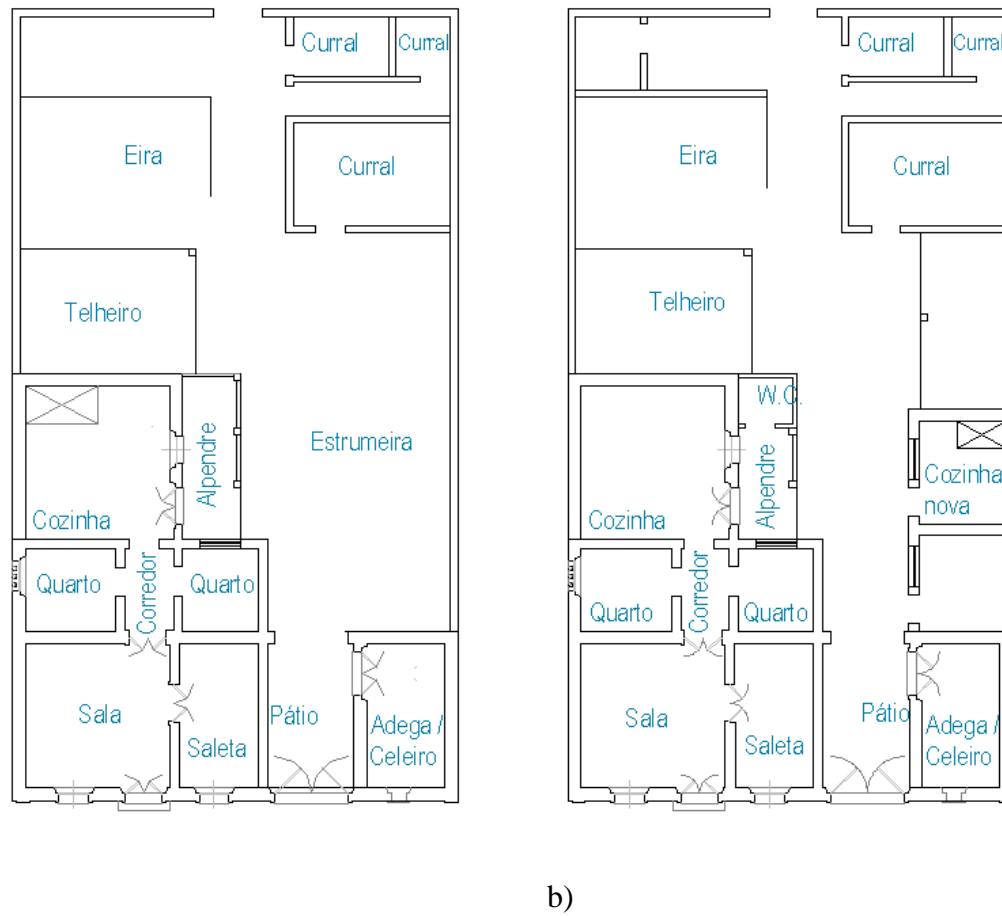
Planta da Casa Gandaresa: a) da construção inicial; b) a que existe presentemente
